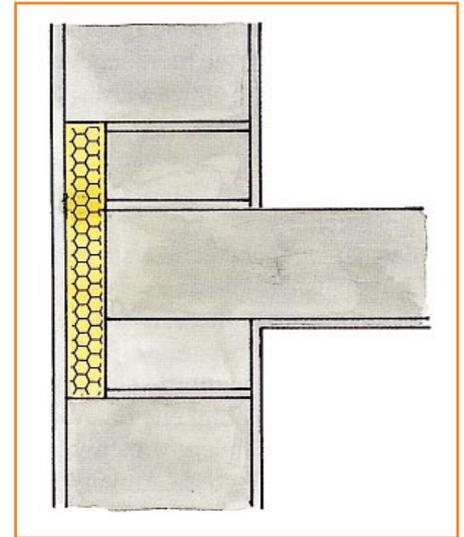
Als Wärmebrücken wirken vielfach Stahlbetondecken im Bereich der Deckenauflage, wenn die äußere Wärmedämmung fehlt. Die häufig gewählte Lösung, einen Dämmstreifen in Höhe der Deckendichte anzubringen, kann den Wärmestrom nach außen nur teilweise verhindern. Auskühlung in der inneren Raumecke und Kondensatbildung sind dadurch nicht auszuschließen. Besser ist es, die Wärmedämmplatten im Deckenauflegerbereich nach unten und oben hinauszuführen. Bild: nach IVH/Reichert
